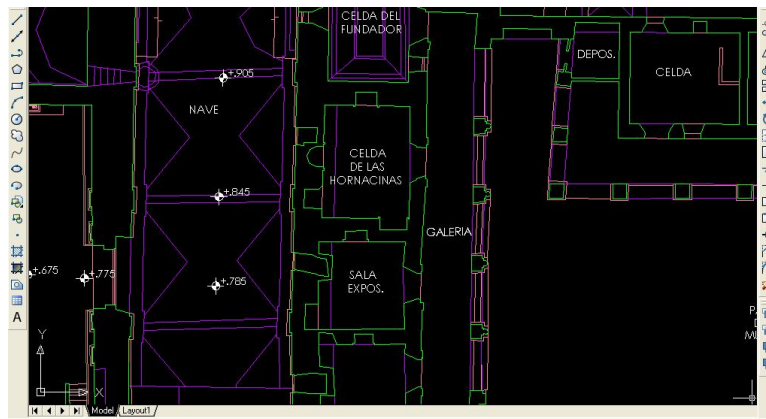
Reconstrucción Planimetría Digital – Convento de Carmelitas Descalzas. Córdoba.
